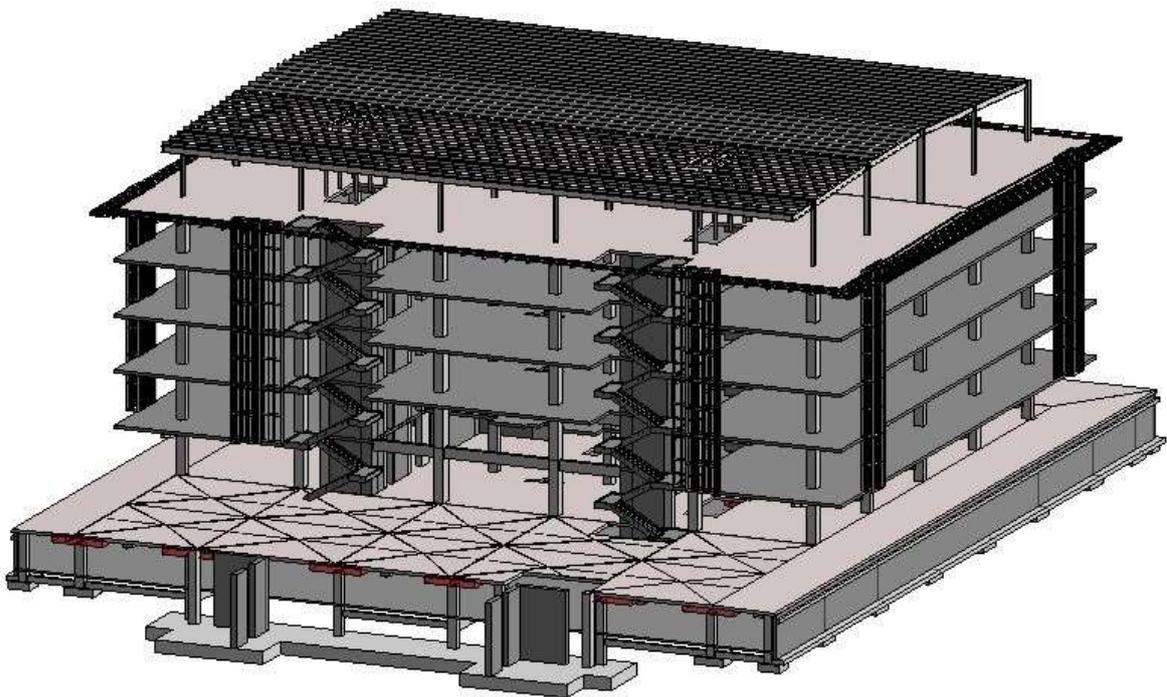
Modelo 3D de Revit del Edificio 1 del proyecto constructivo real
